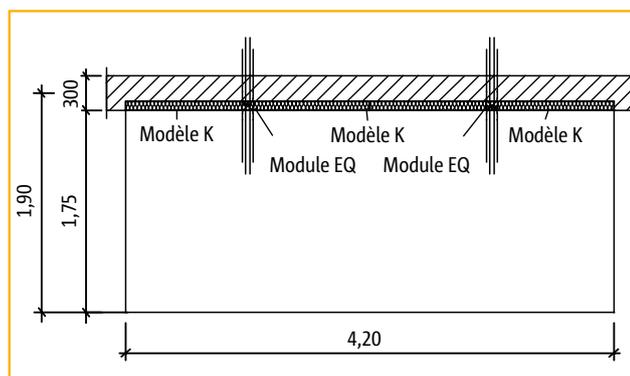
Vue en plan - disposition des éléments du rupteur Isokorb®
